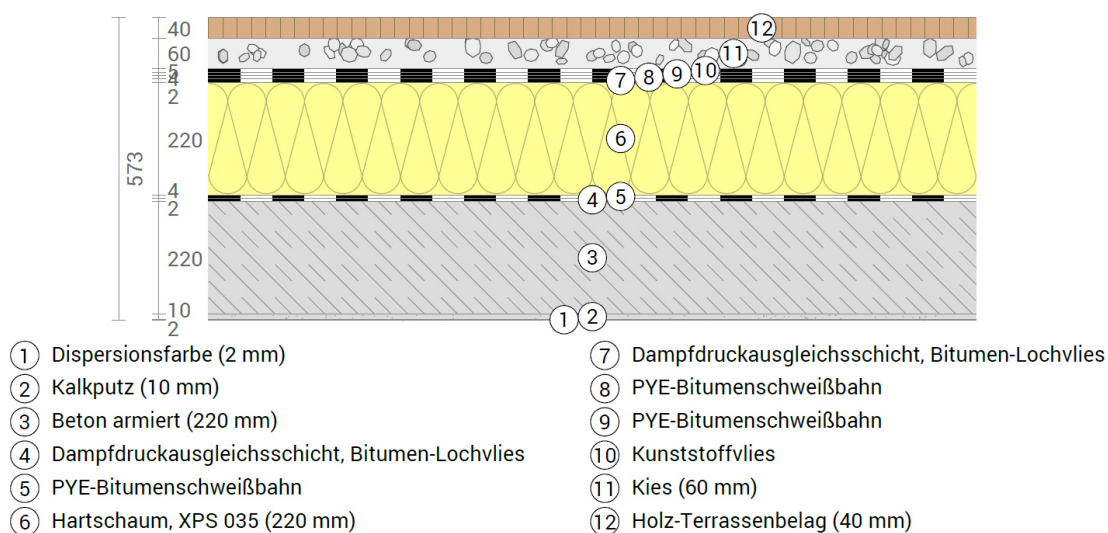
Bauteilaufbau der Dachterrasse (KNB-Variante)
